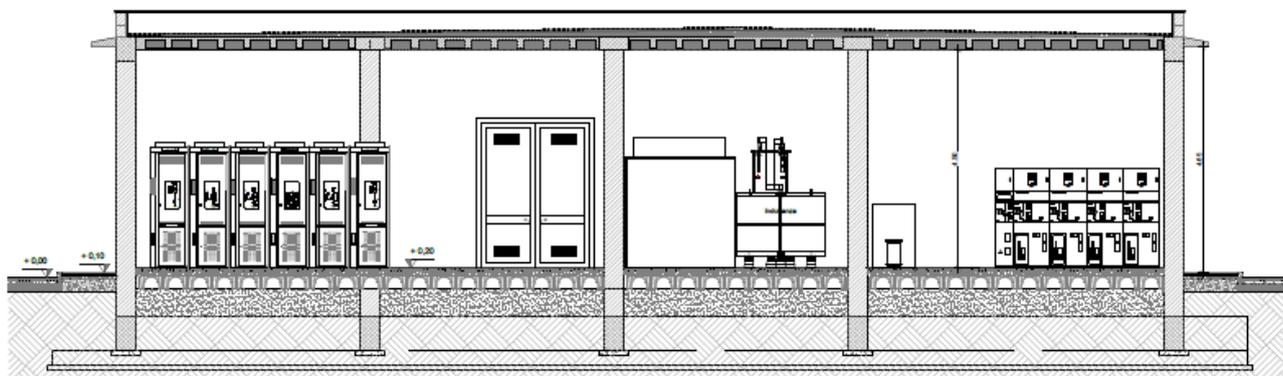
Pianta fabbricato di SSE Tipo 1
